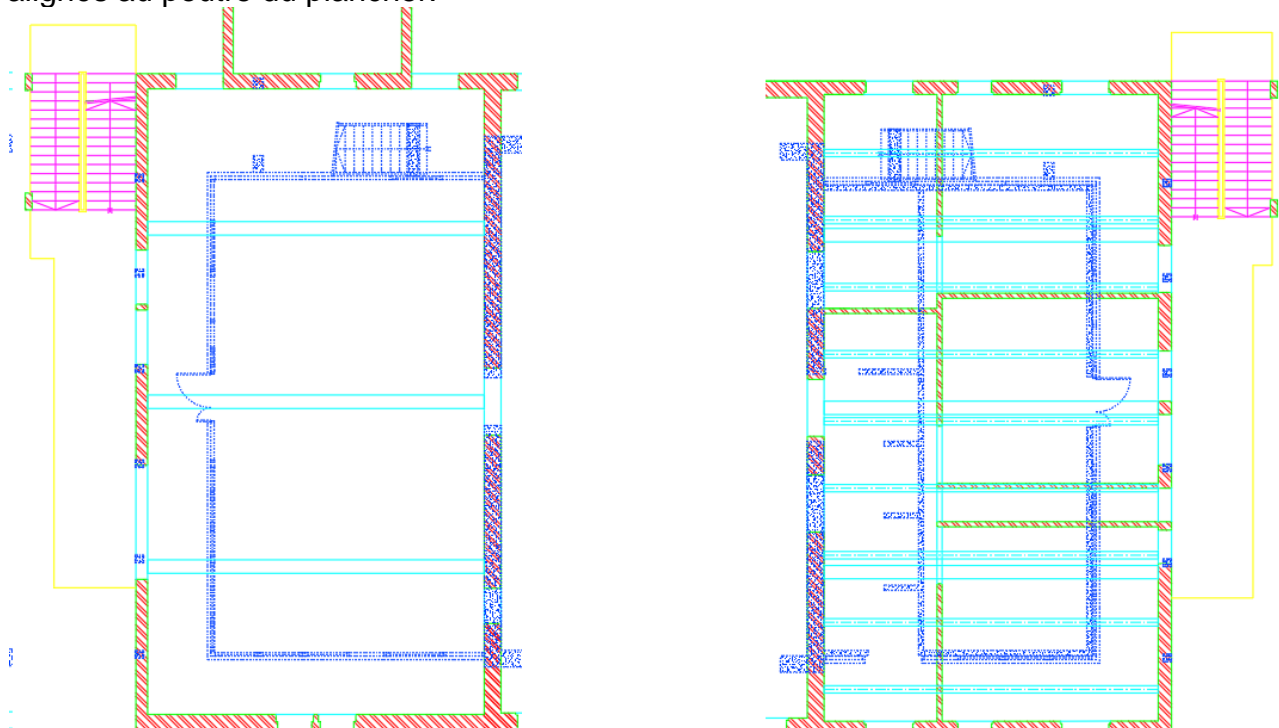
& 30 : Planches haut R+1 aile Ouest & Est
